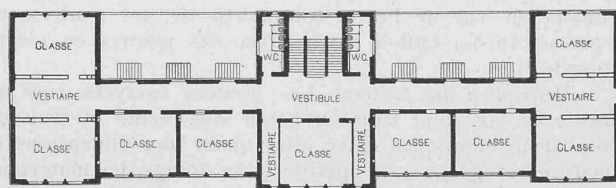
Plan du premier étage. — Echelle 1 : 800.
